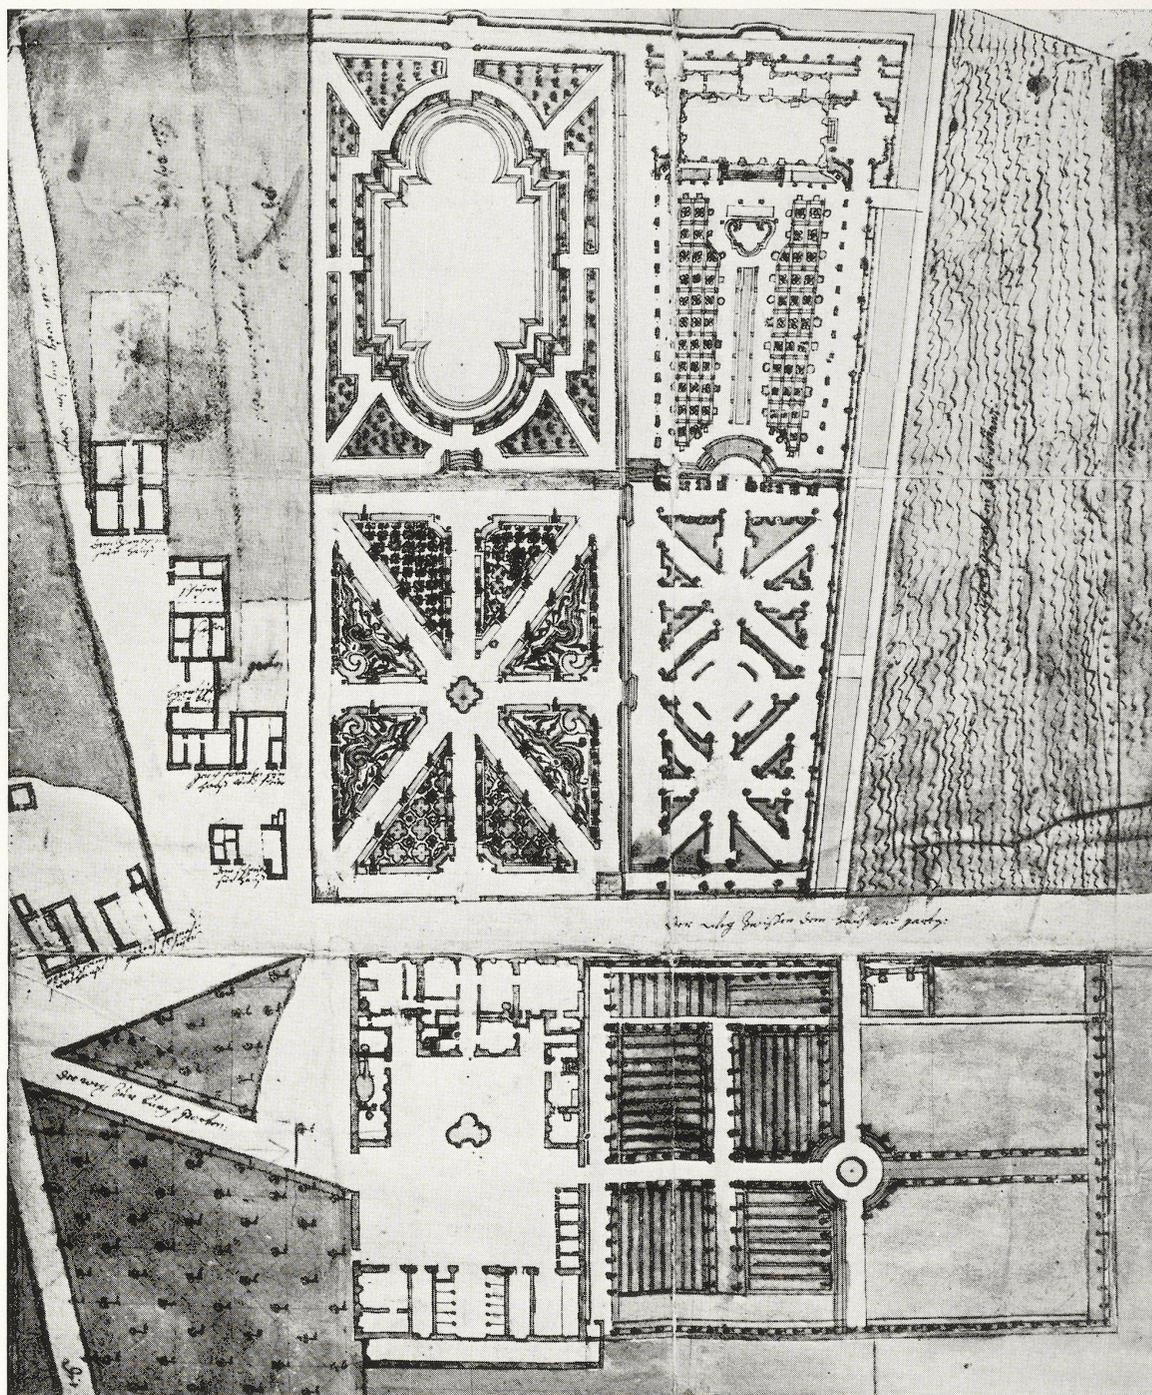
Bekond, Lageplan um 1732 (P13, oben ist Norden)
